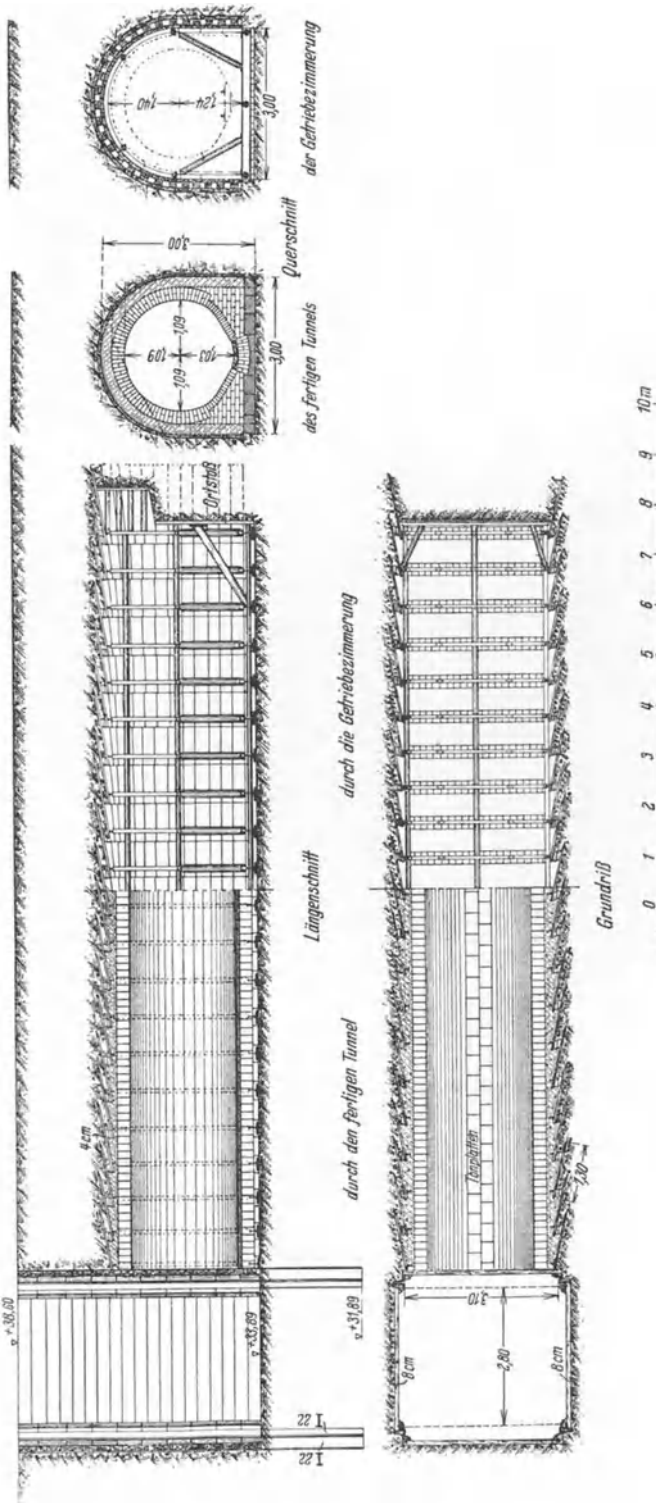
Tunnelbau mit Getriebezimmern in Charlottenburg¹.
